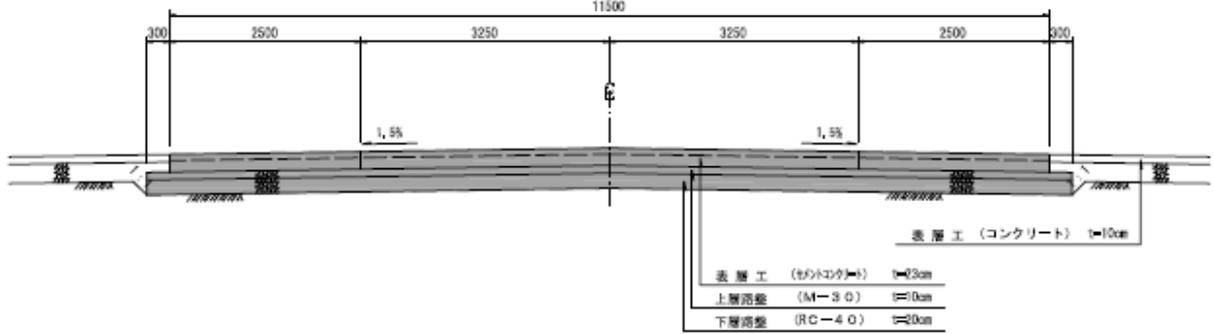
313 No.1 日立港区_第1埠頭2号・3号・4号道路の平面図 (第1埠頭3・4号道路) (復旧後)
